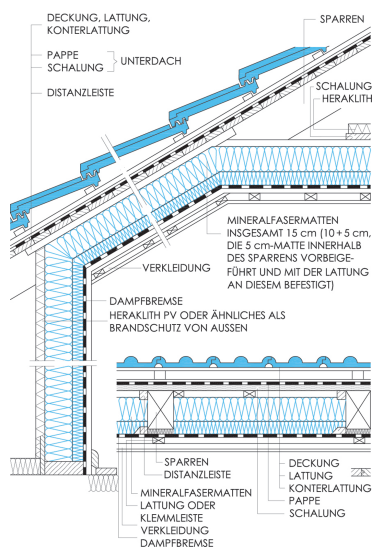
Bauteile im Dachgeschoßausbau [Quelle: Riccabona/Mezera, Baukonstruktionslehre 2 (Ausgabe 2011) 162]
